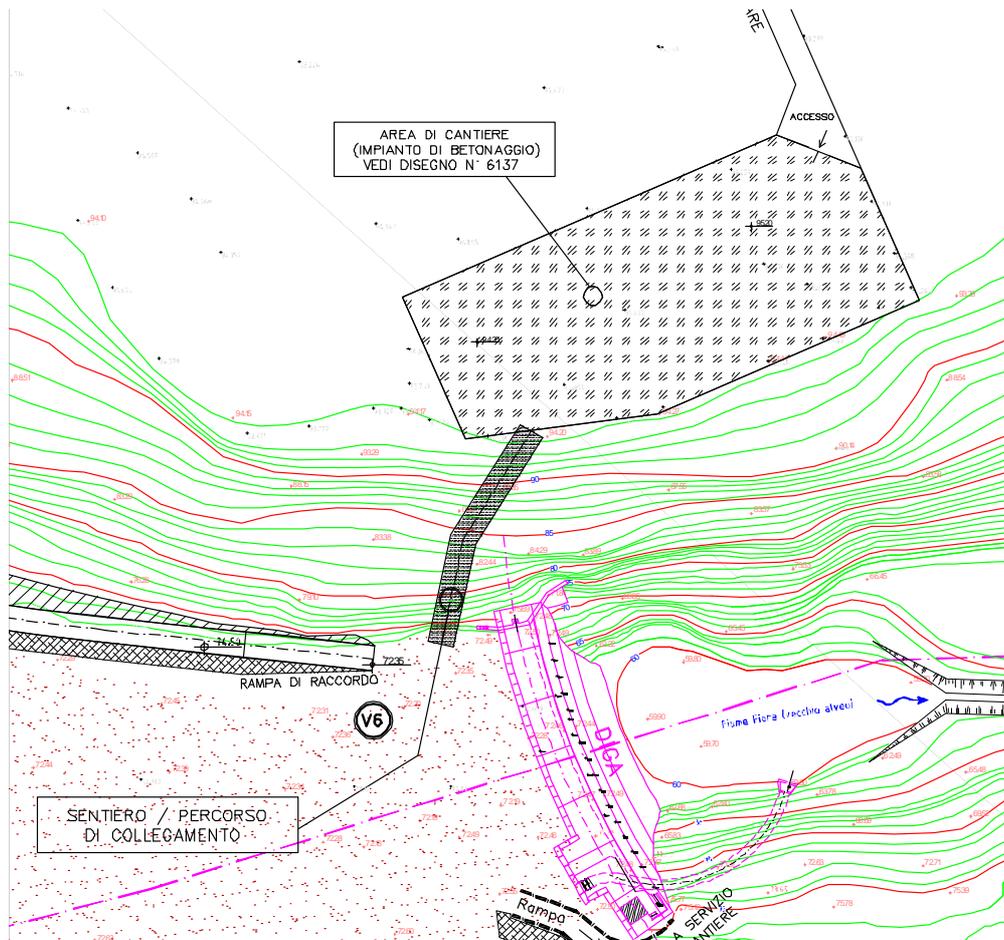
Localizzazione dell'area di cantiere in sponda sinistra
